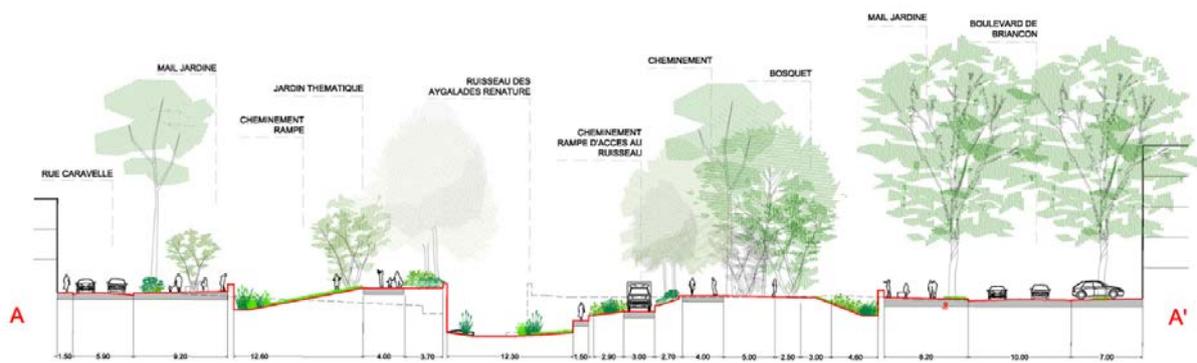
Coupe AA' du parc Bougainville au sud du site (EPAEM)
